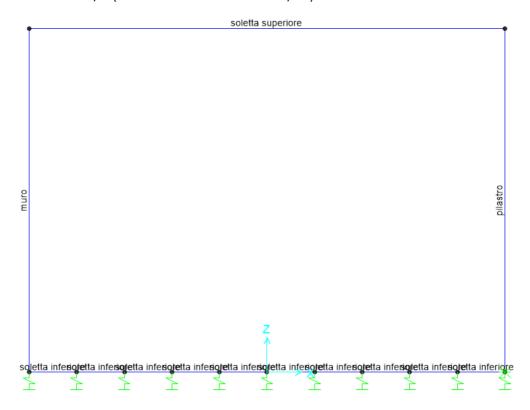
modello bidimensionale della porzione di galleria analizzato su Sap2000
